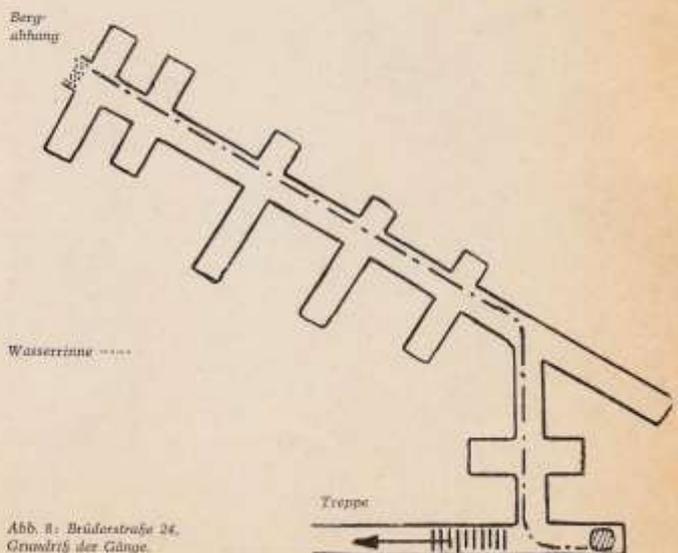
Brüderstraße 24, Grundriß der Gänge.
